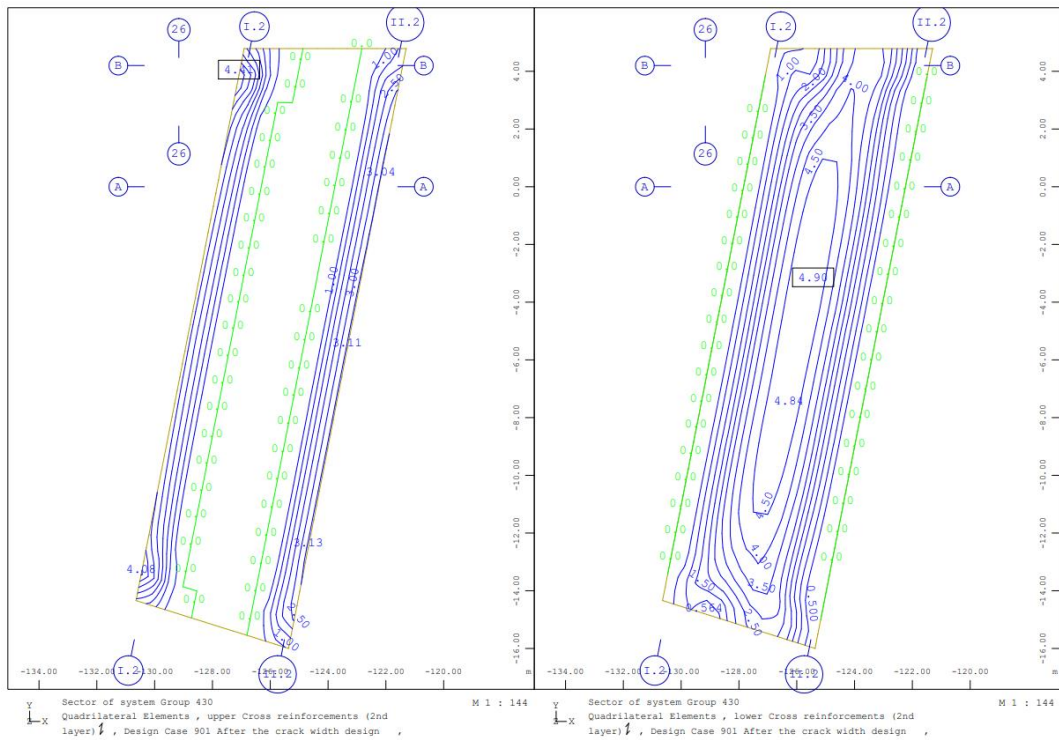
Armadura secundária na face superior (esq.) e inferior (dir.) – laje de cobertura – túnel - ELS
